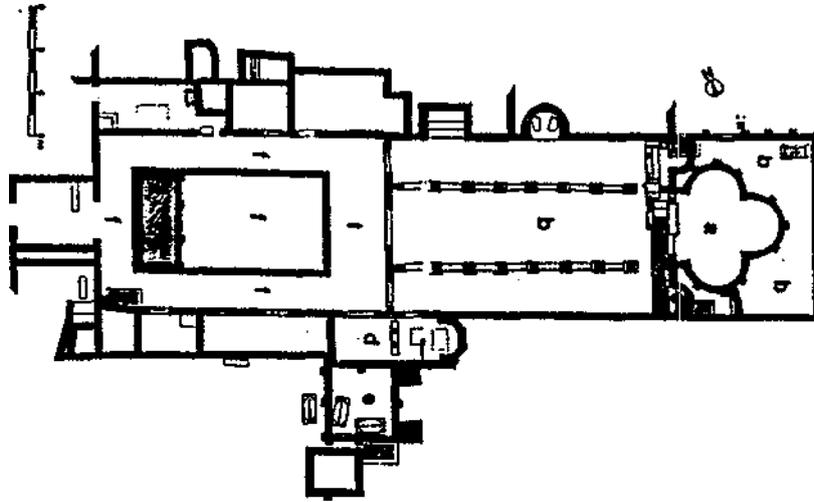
Planta dei complejo cultural de Santa Andrea (Bettica, Istria, Itália).
